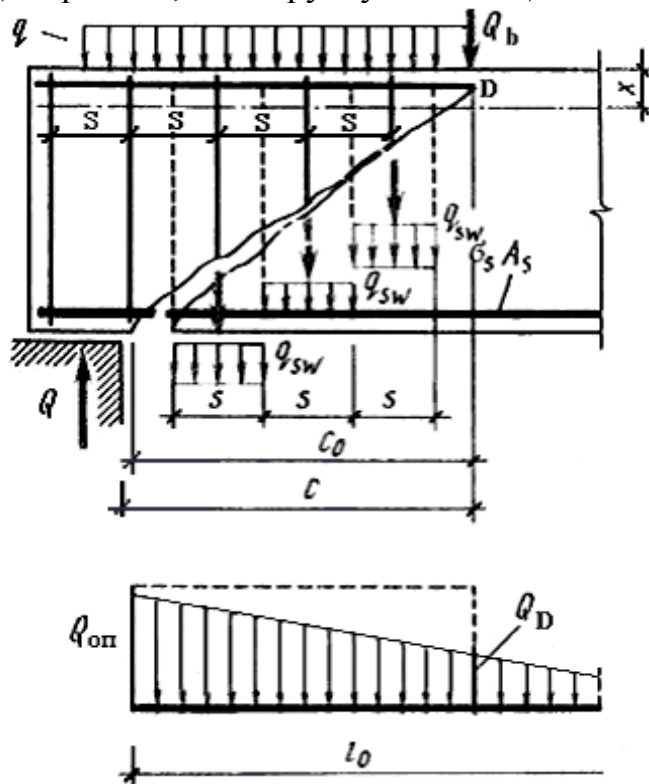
Розрахункова схема по похилим перерізам для випадку від дії поперечної сили
